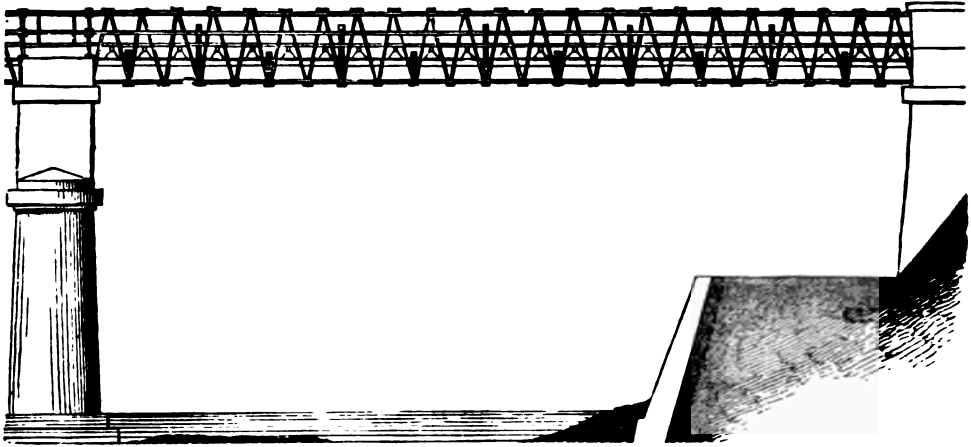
Tracé d'un pont de 22 mètres d'ouverture, suivant le système Neville.
